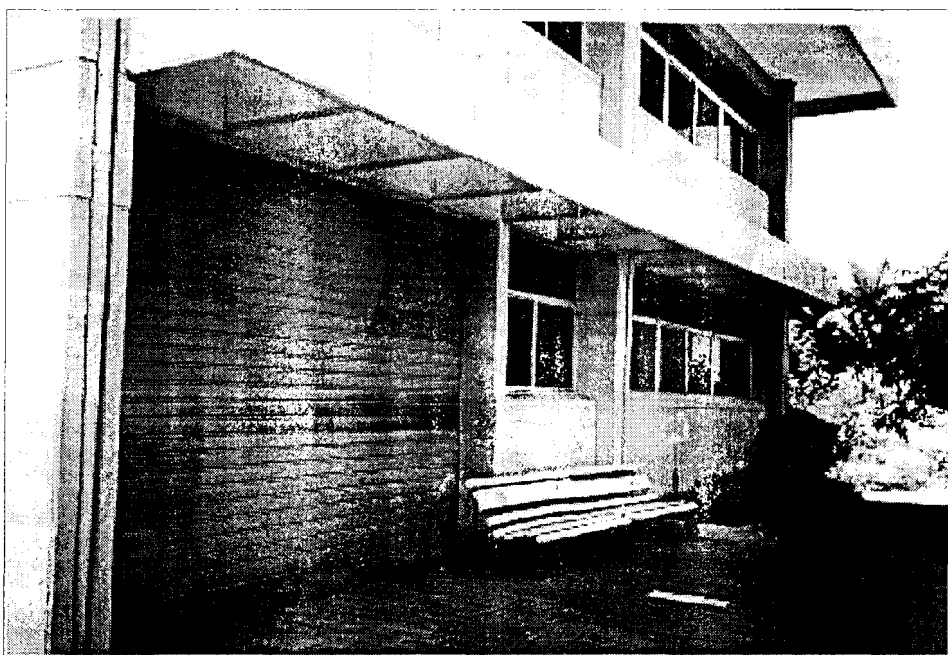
Laboratorios F.I.C.T.:* Geología: puerta metálica de tol con chapa.
